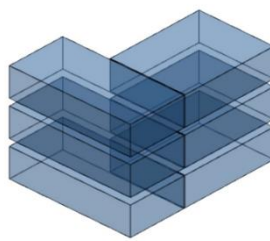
Grundrisstypen aus dem Grundrisskatalog - Baugruppen-Wohnung (BG-W)
